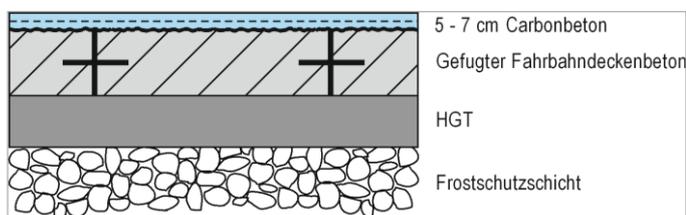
Schema des Verbundsystems "gefugter Unterbeton – carbonbewehrter Oberbeton"
